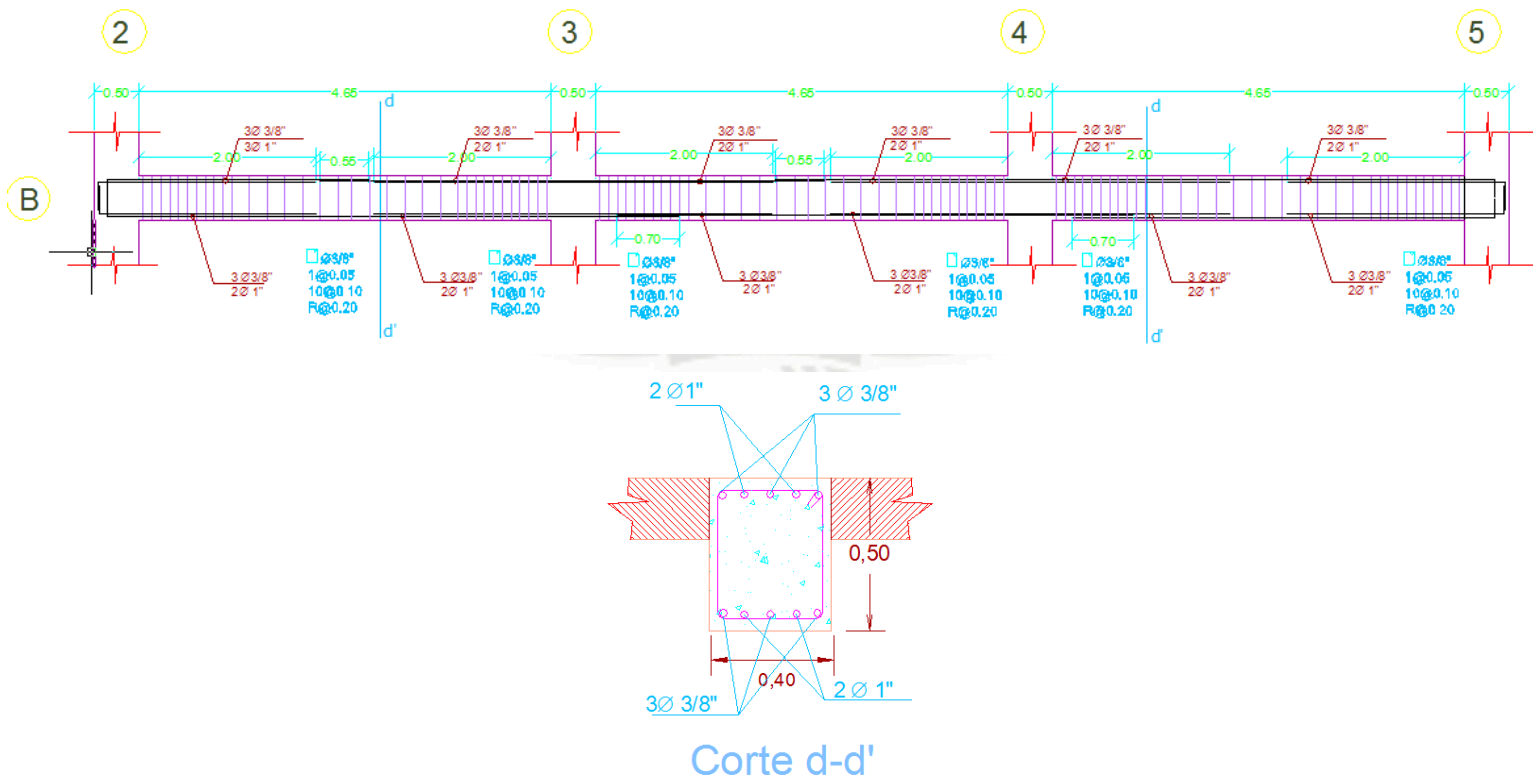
y. Diseño final viga Eje B modelo aislado
